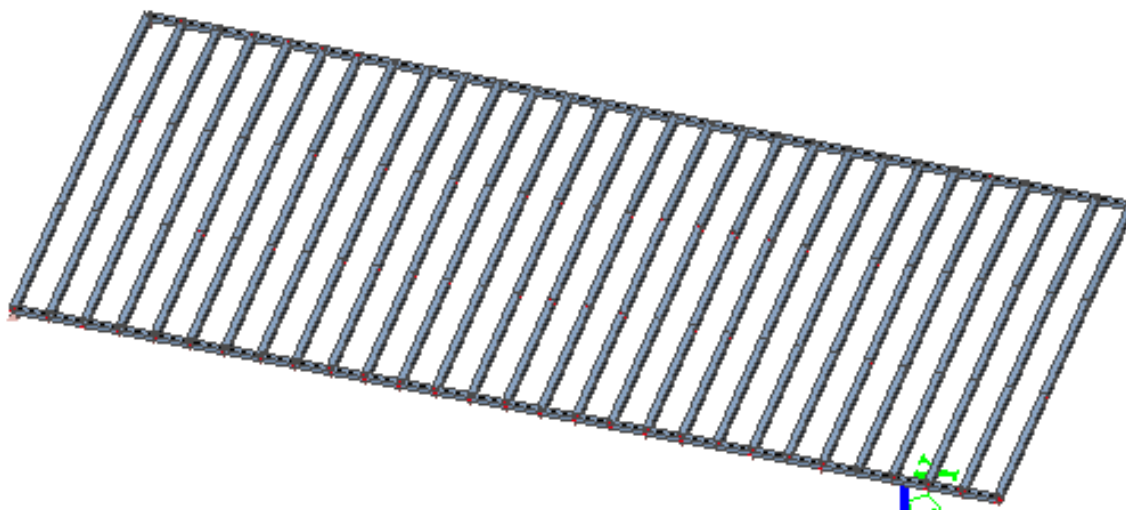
vnitřní nosná konstrukce 4NP (stávající stav)
